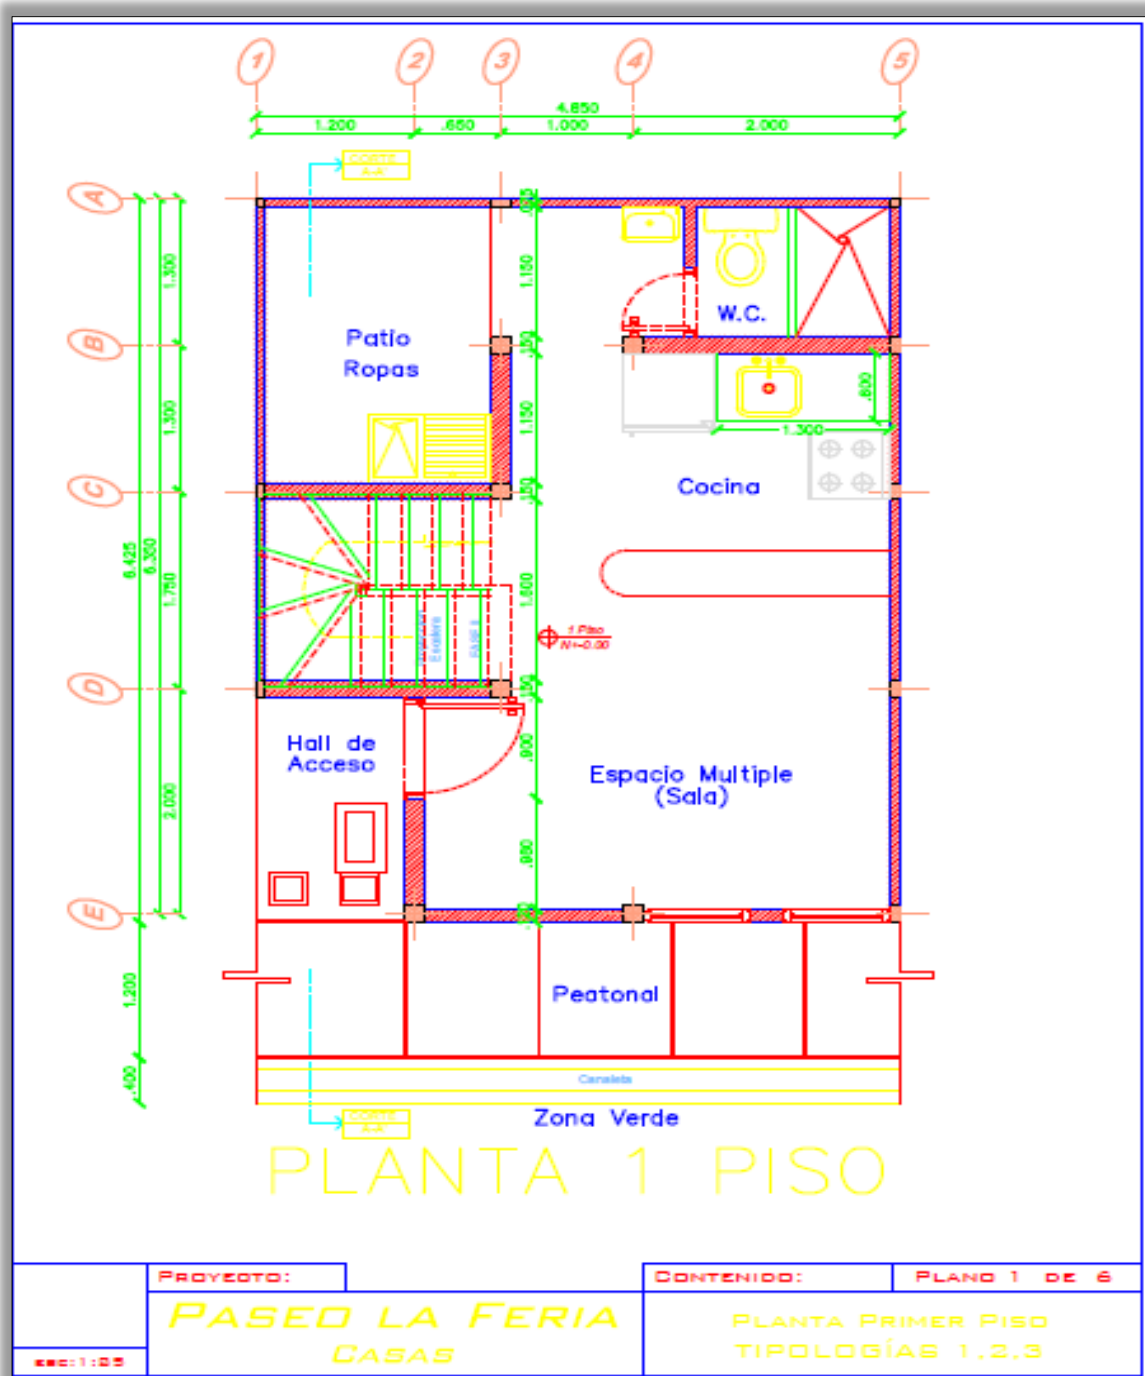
Plano primera planta: vivienda tipo seleccionada [20]
